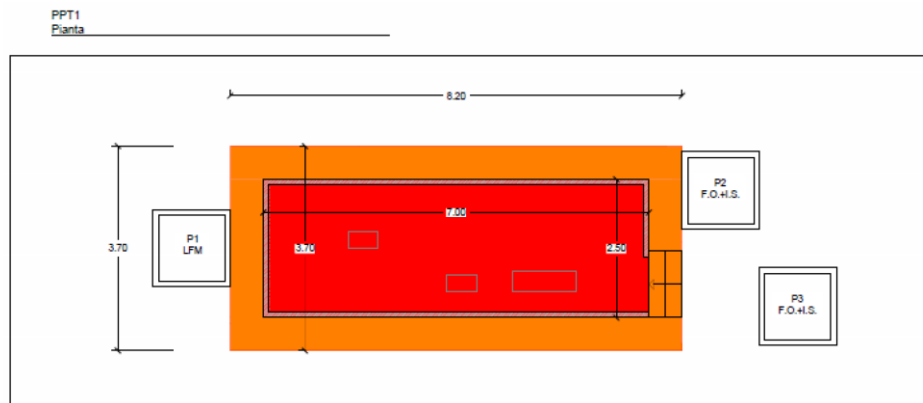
Planimetria fabbricato tecnologico GA Tortona
